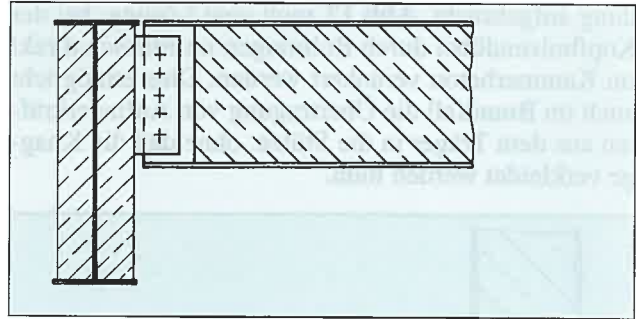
Konventioneller Fahnenblechanschluß mit nachträglichem Brand schutz
